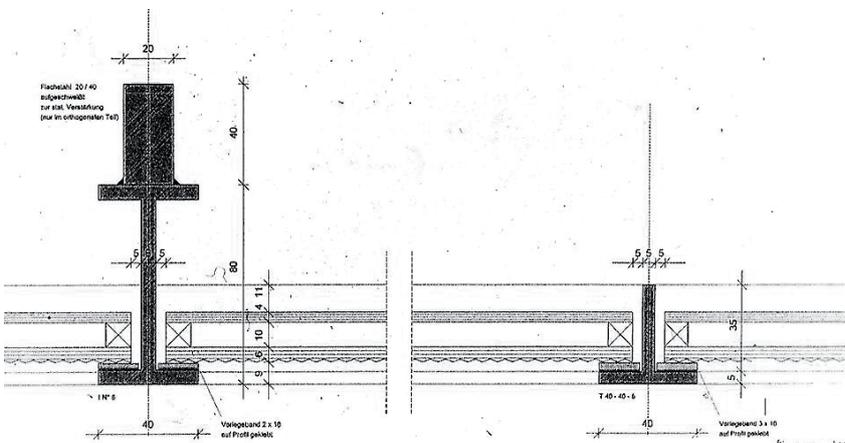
Detail der nachgerüsteten Lichtdecke im Rundbau. Prismen- und Sicherheitsglas sind zu Isolierglasscheiben verbunden.
